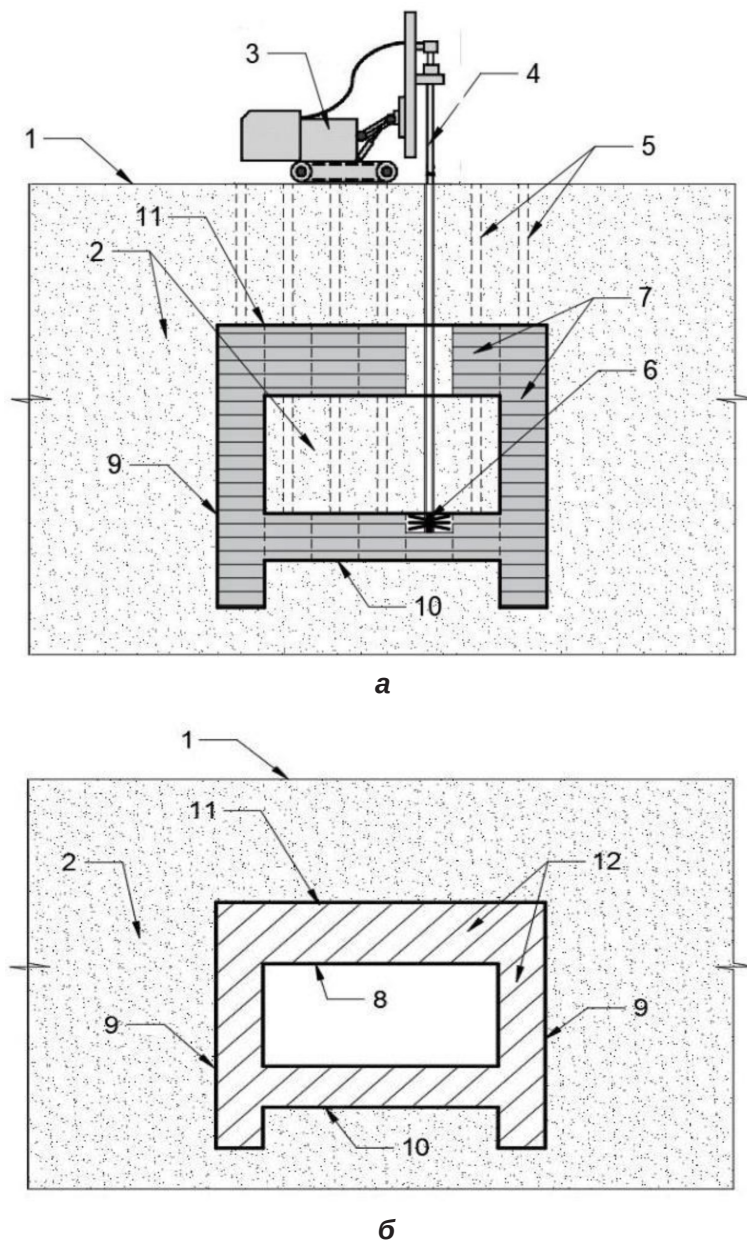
Схема зведення підземних споруд із ґрунтобетону:
